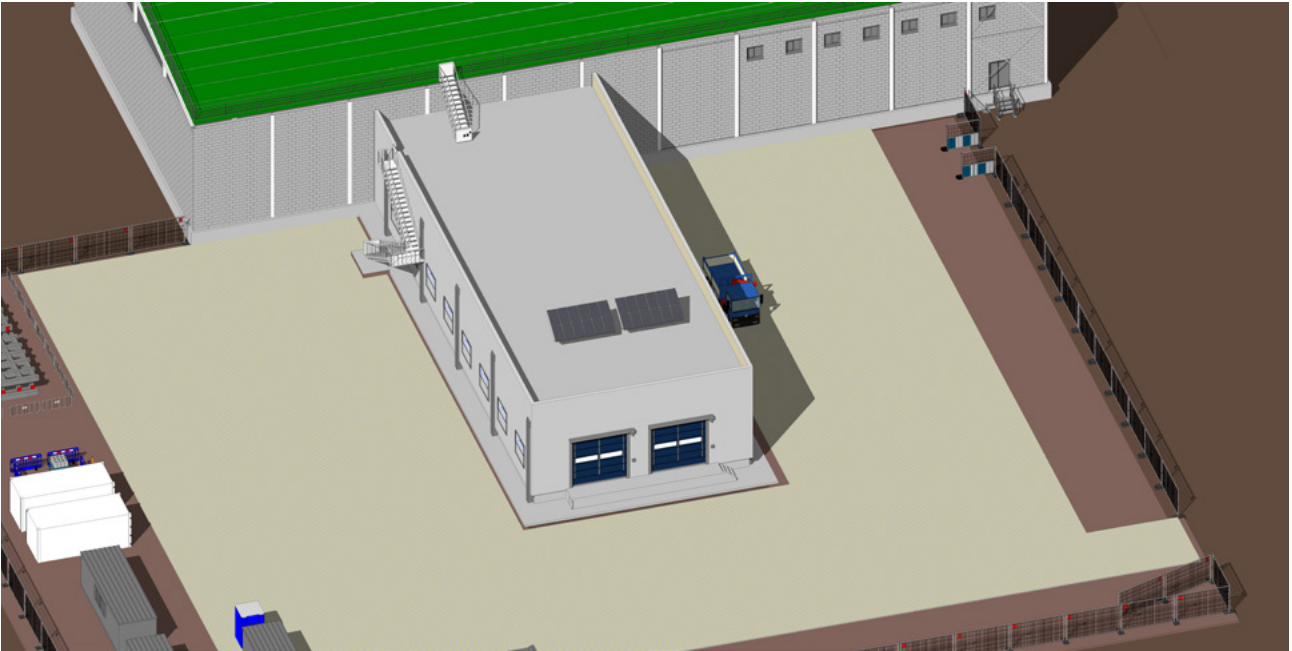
Recreación de paneles fotovoltaicos sobre la cubierta plana
